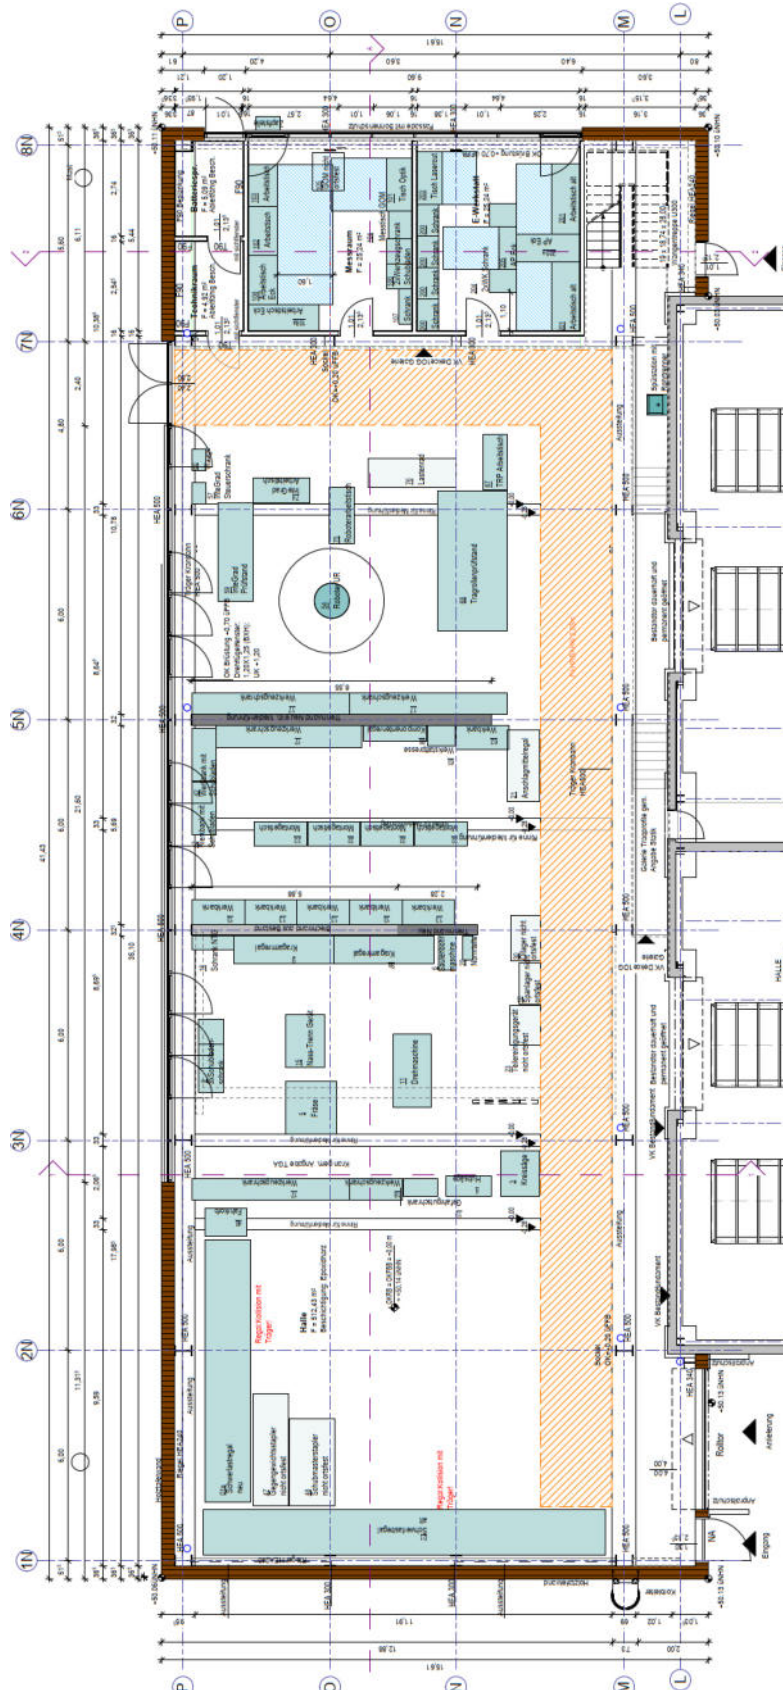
Grundriss Erdgeschoss (Vorabzug) 29337-IPH-30-OPG-02-GR-100
